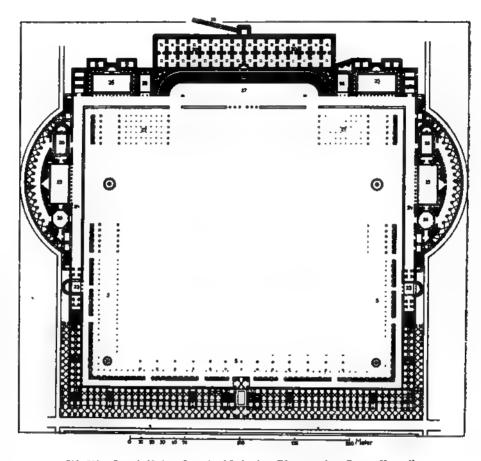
Grundrig ber hauptgebande ber Thermen ber Caracalla ju Rom.
